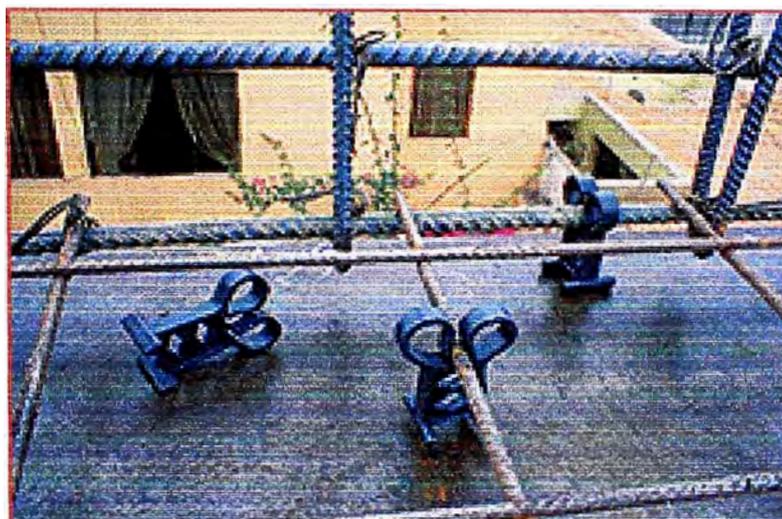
Detalle de los separadores para asegurar el recubrimiento del refuerzo de Losa
